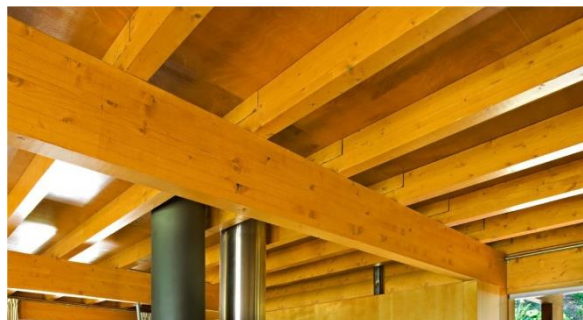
Pormenor Vigas Expostas Tecto, Casa Caniçadas #02-*Modular System*.
